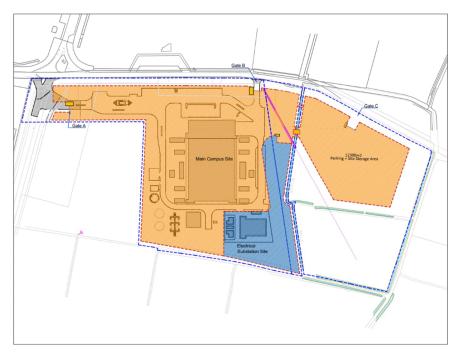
Occupazione temporanea delle aree di cantiere previste.
